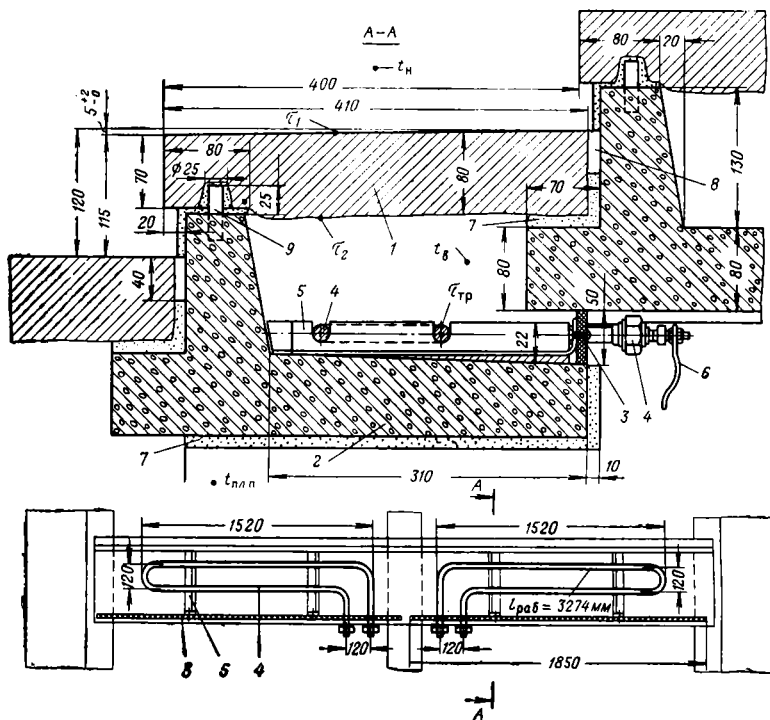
X. Общий вид ступени лестничного свода с трубчатым электронагревателем ТЭН:
